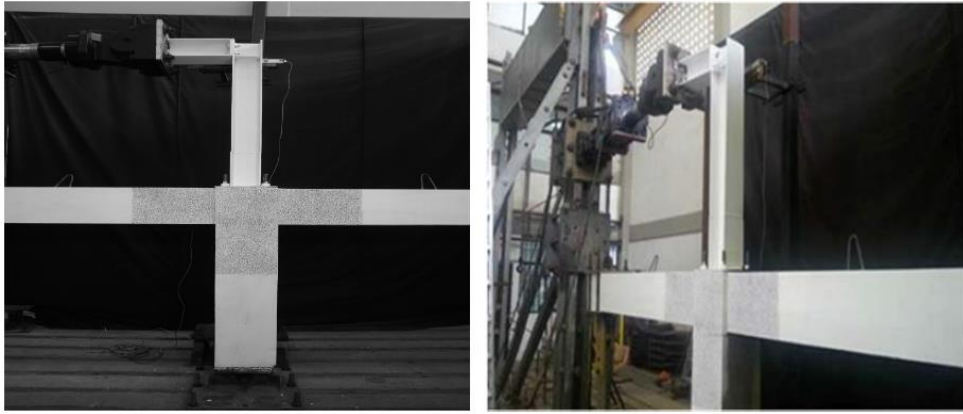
Probeta ensayada por Ugel [2]. Fuente:[5]
